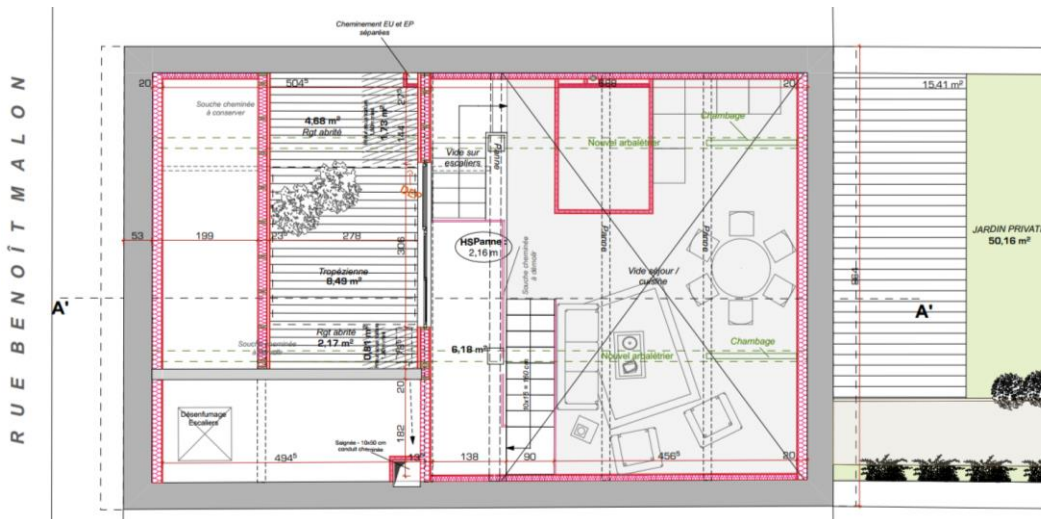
Plan R+3 du bâtiment au 40, rue Benoît Malon. Source : Permis de Construire, archive EPASE.
